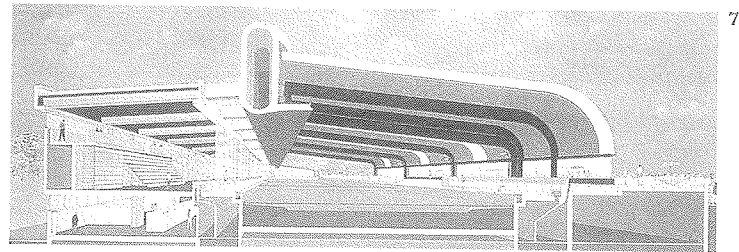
Prospetto e fasi costruttive dello Stadio Meazza a Milano.
